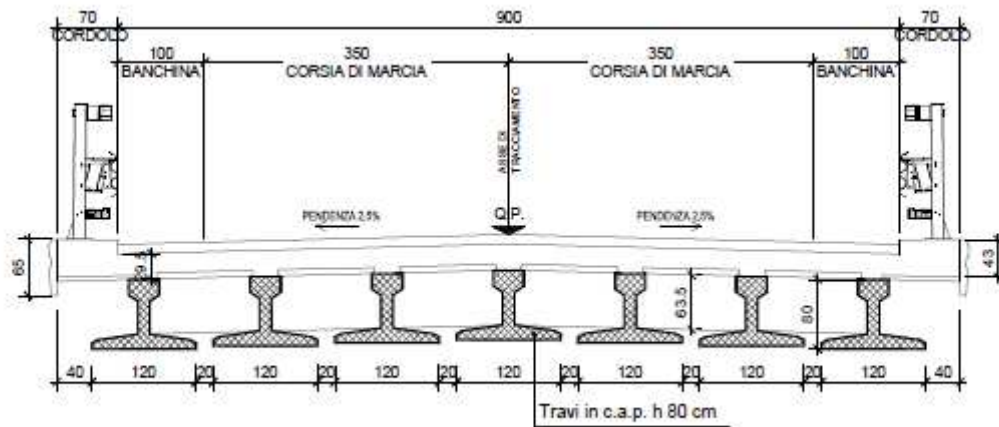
Sezione impalcato Ponte sul Cavo Porretto
